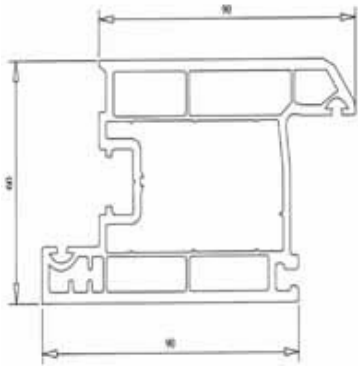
Tekli Kasa Profil Kesiti (sürme)
